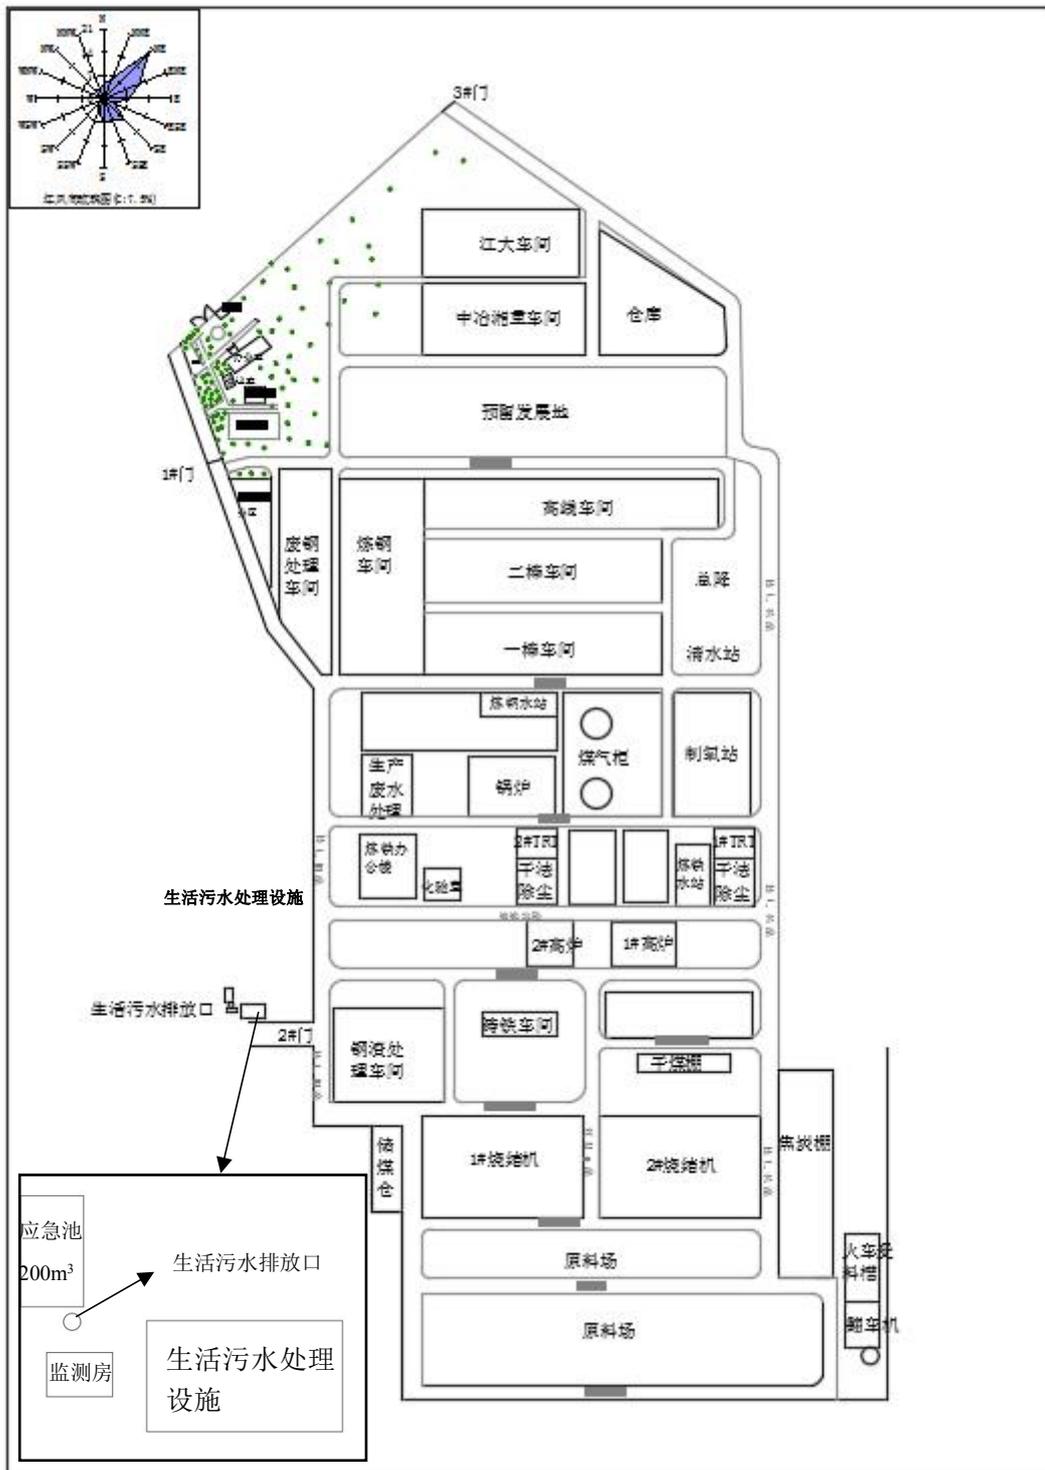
阳春新钢铁有限责任公司总平面布置图
